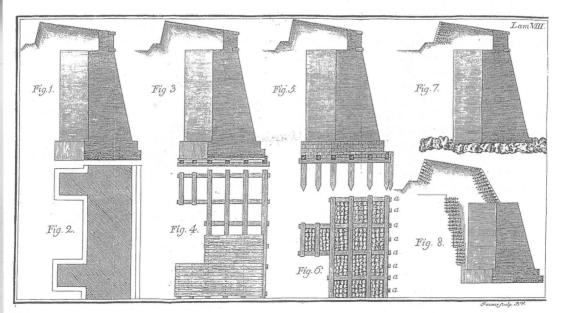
John Muller, *Tratado de fortificación* ò *Arte de Construir*...(1769). Lam. VIII, perfil de la muralla y cimentación
